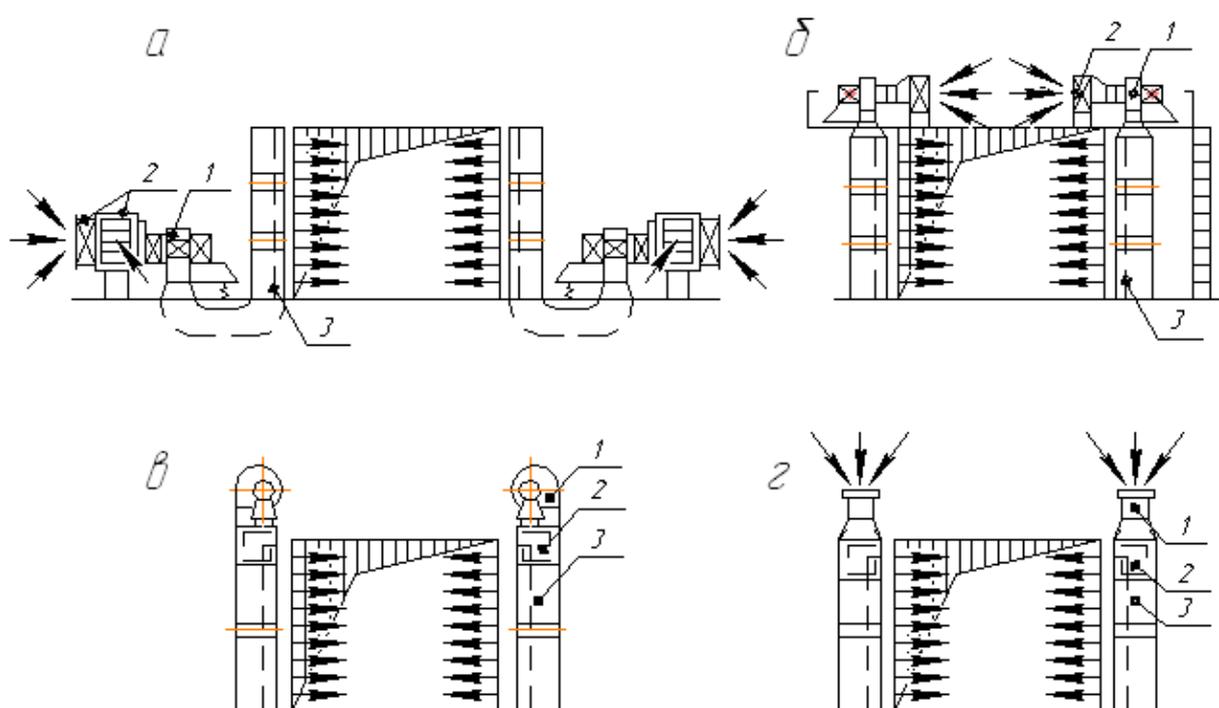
Основные схемы размещения агрегатов завес щиберующего типа: *а* – расположение центробежных вентиляторов и калориферов на полу; *б* – расположение центробежных вентиляторов на площадке над воротами; *в* – расположение центробежных вентиляторов и калориферов на различных коробах; *г* – расположение осевых вентиляторов и калориферов на раздаточных коробах; 1 – вентилятор; 2 – калорифер; 3 – раздаточный короб
